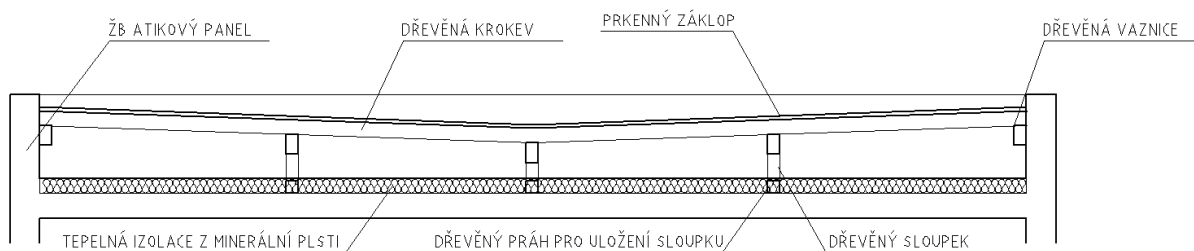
Schéma příčného řezu- Varianta s železobetonovým horním pláštěm
